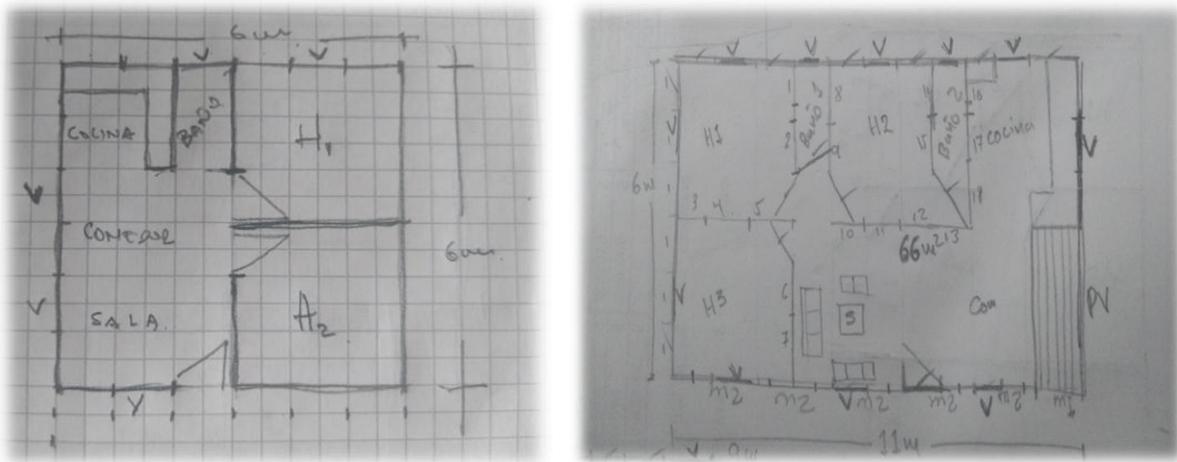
Planta Distribución Existente, Esquema Básico. Fuente: Intera Sas.
